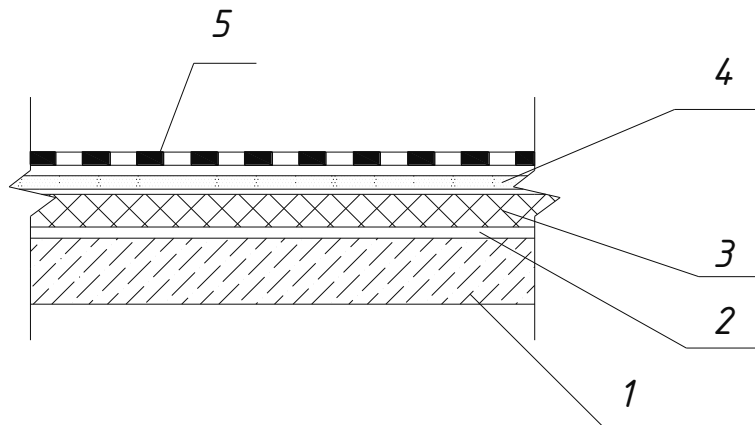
Переріз огорожувачої конструкції покриття:
